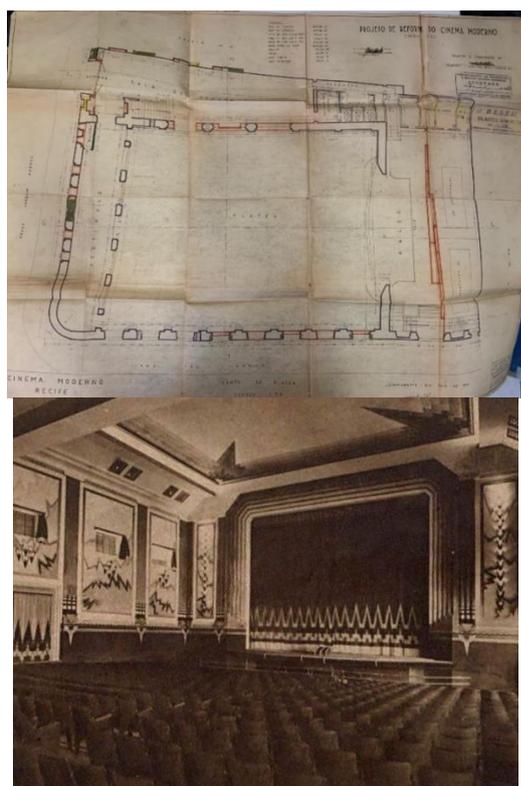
Corte do Cineteatro Moderno e Planta baixa do mezanino (balcão) de 1953
